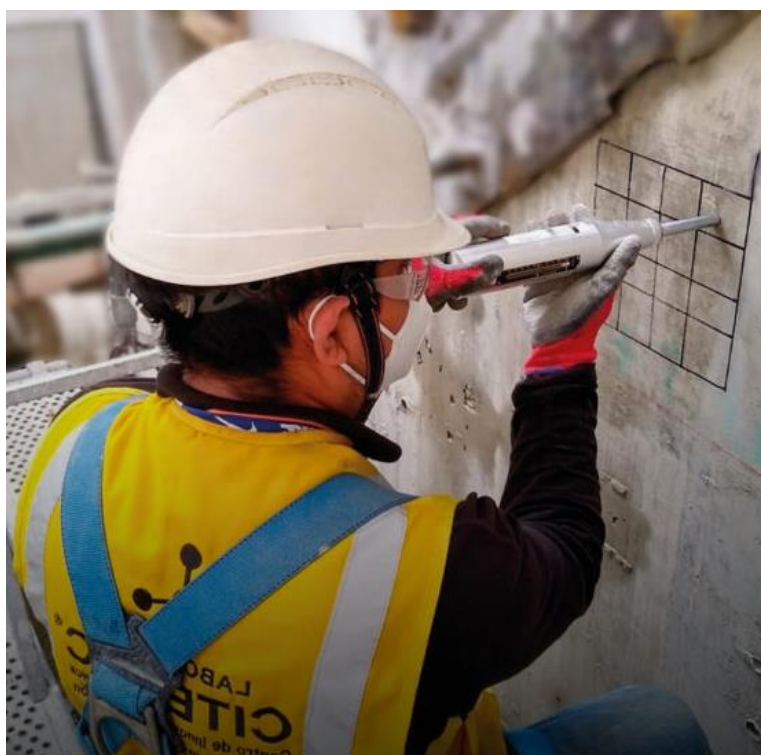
Ensayo de esclerometría aplicado en una estructura de hormigón. (Laboratorio-Citemac, 2023).
